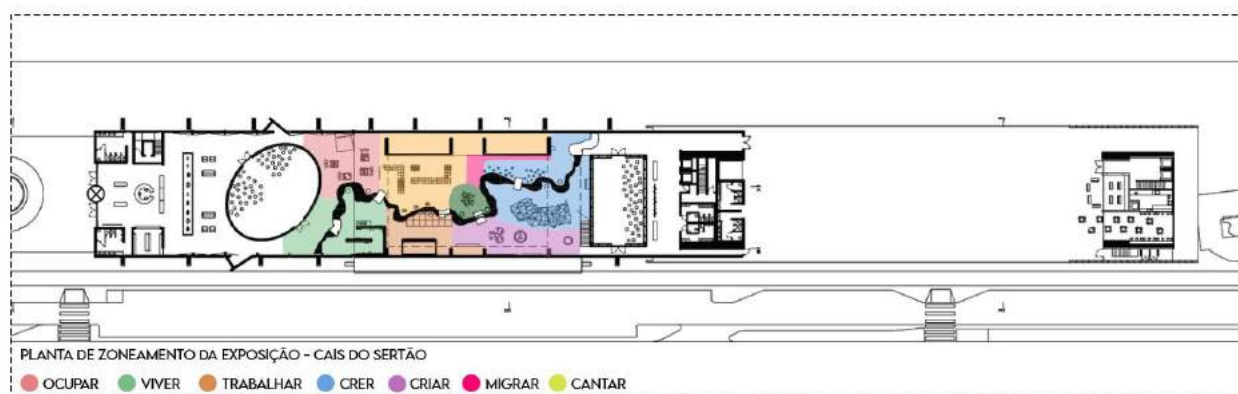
Planta baixa do pavimento térreo do Museu Cais do Sertão com setorização dos territórios temáticos.
